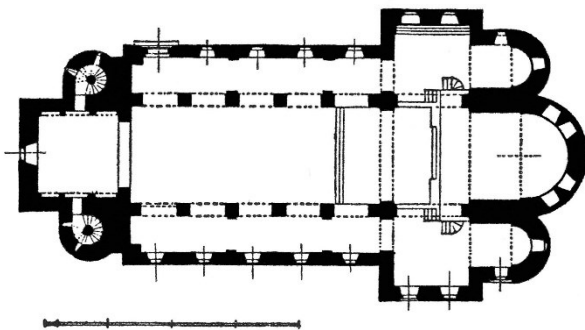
Grundriss von St. Hadelin in Celles
